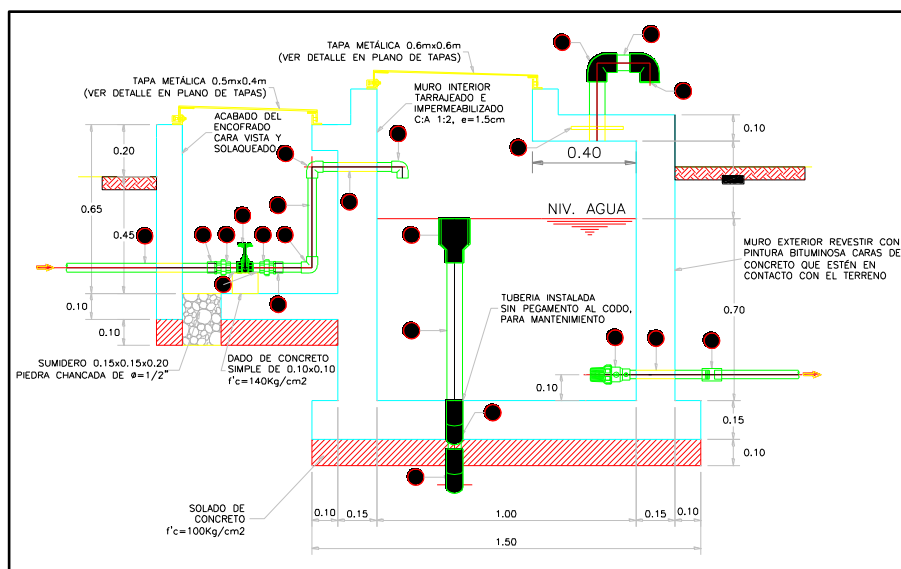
Vista de Elevación de la Cámara Rompe Presión Tipo 6 Proyectada
